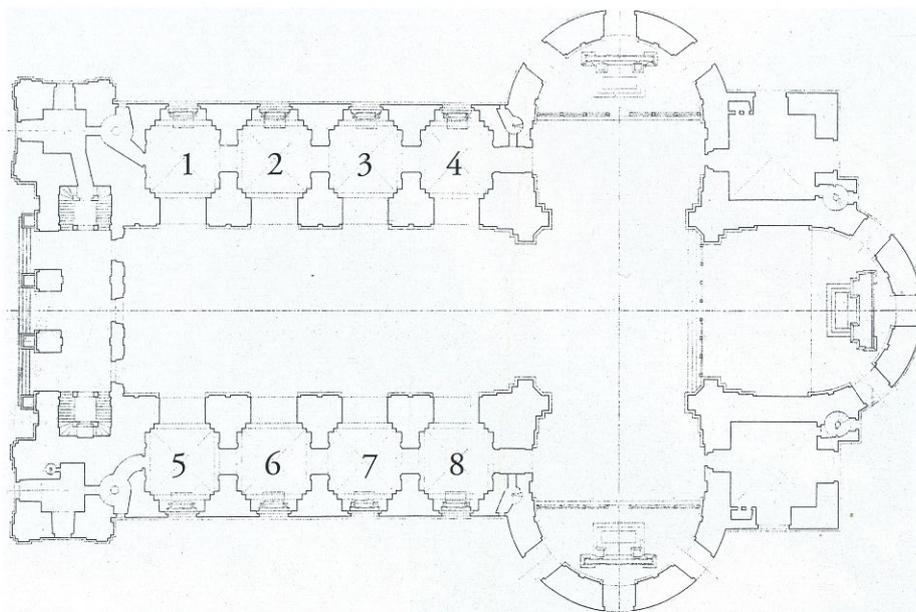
(rechts): Grundriß des Salzburger Doms (Bauamt der Erzdiözese Salzburg) mit eingetragener Numerierung der Seitenkapellen mit ihren Altargemälden:
